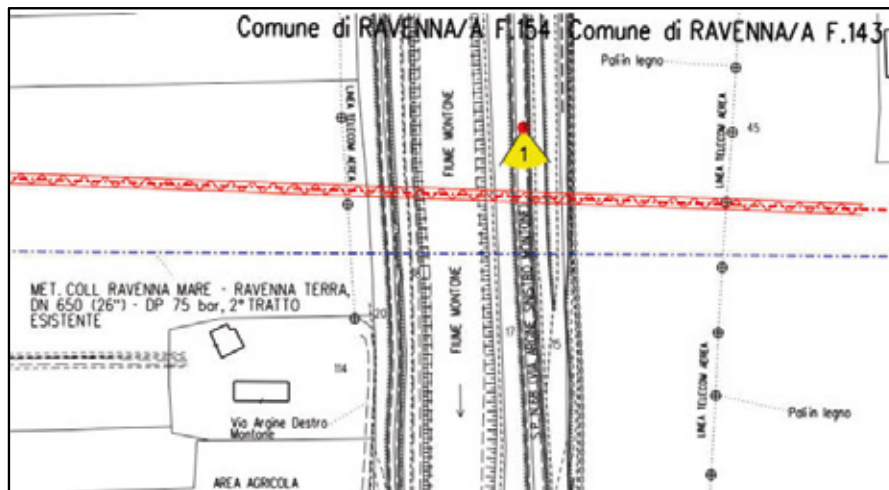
Stralcio planimetrico con punti di ripresa in corrispondenza dell'attraversamento della S.P. N. 68 con il metanodotto in progetto (in rosso)
